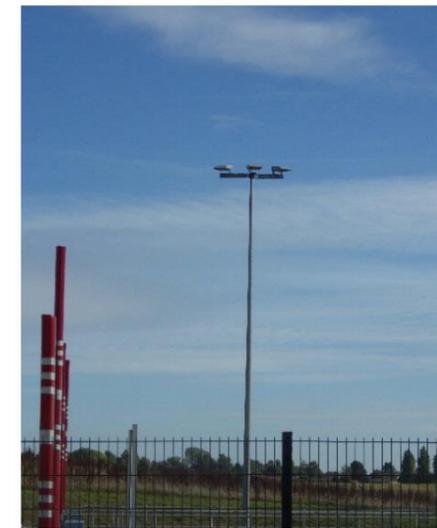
Mat lampadaire section courante BPV – PR16.08 (Photo RBC Projet septembre 2016)
